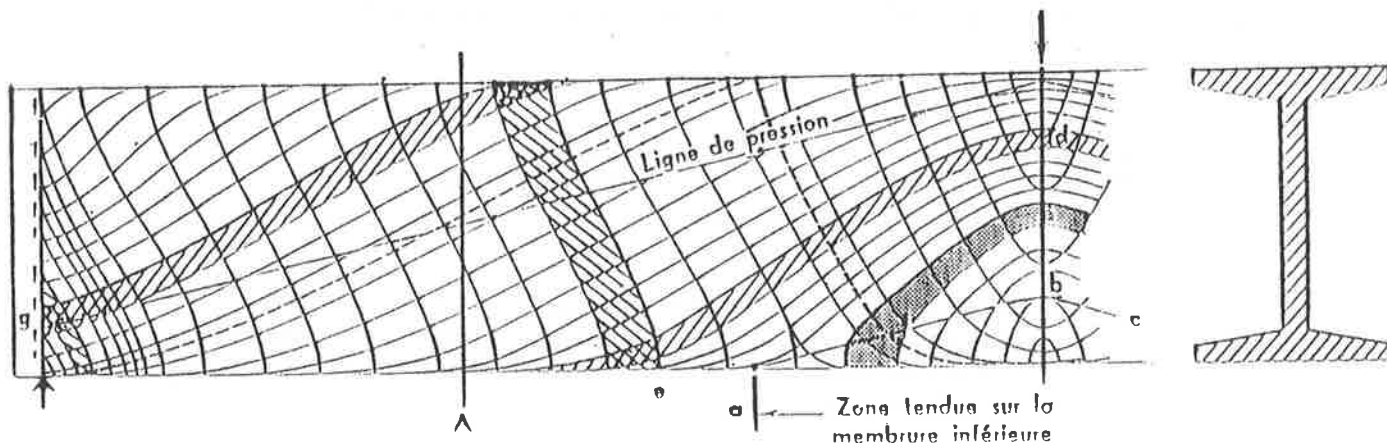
Andamento delle isostatiche in trave a doppio T a p.parziale
